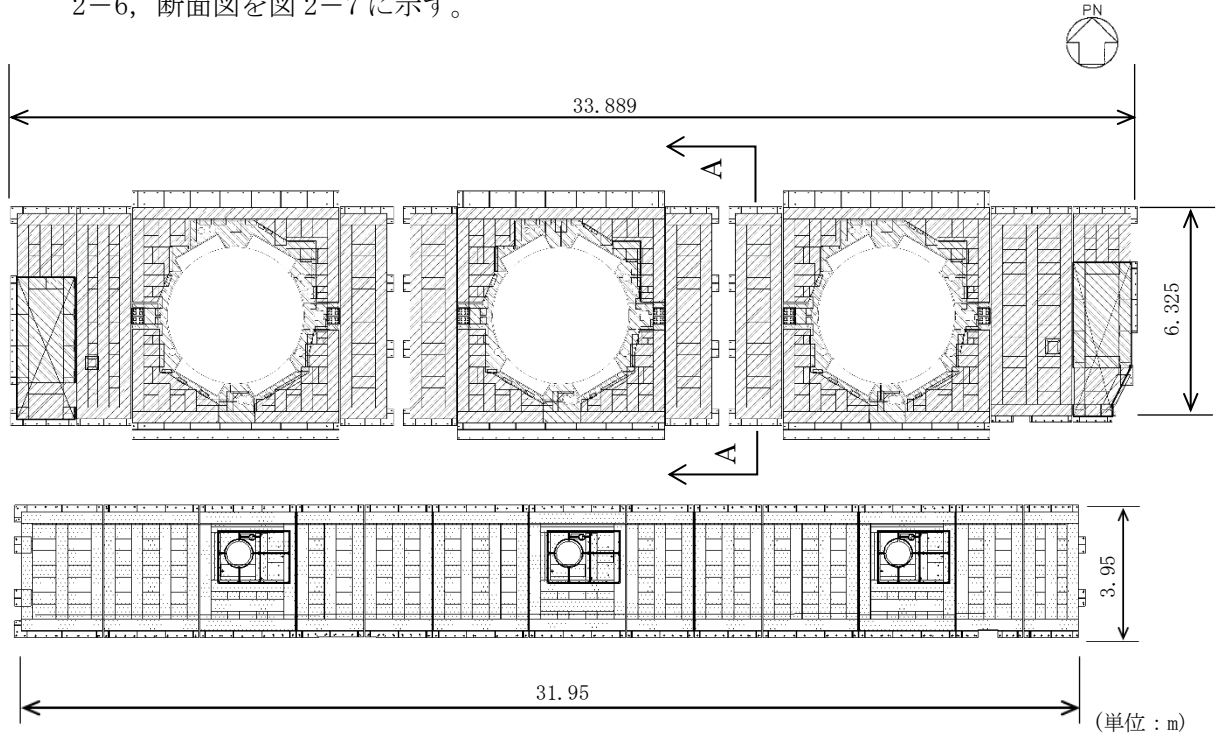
取水槽循環水ポンプエリア防護対策設備の平面図
